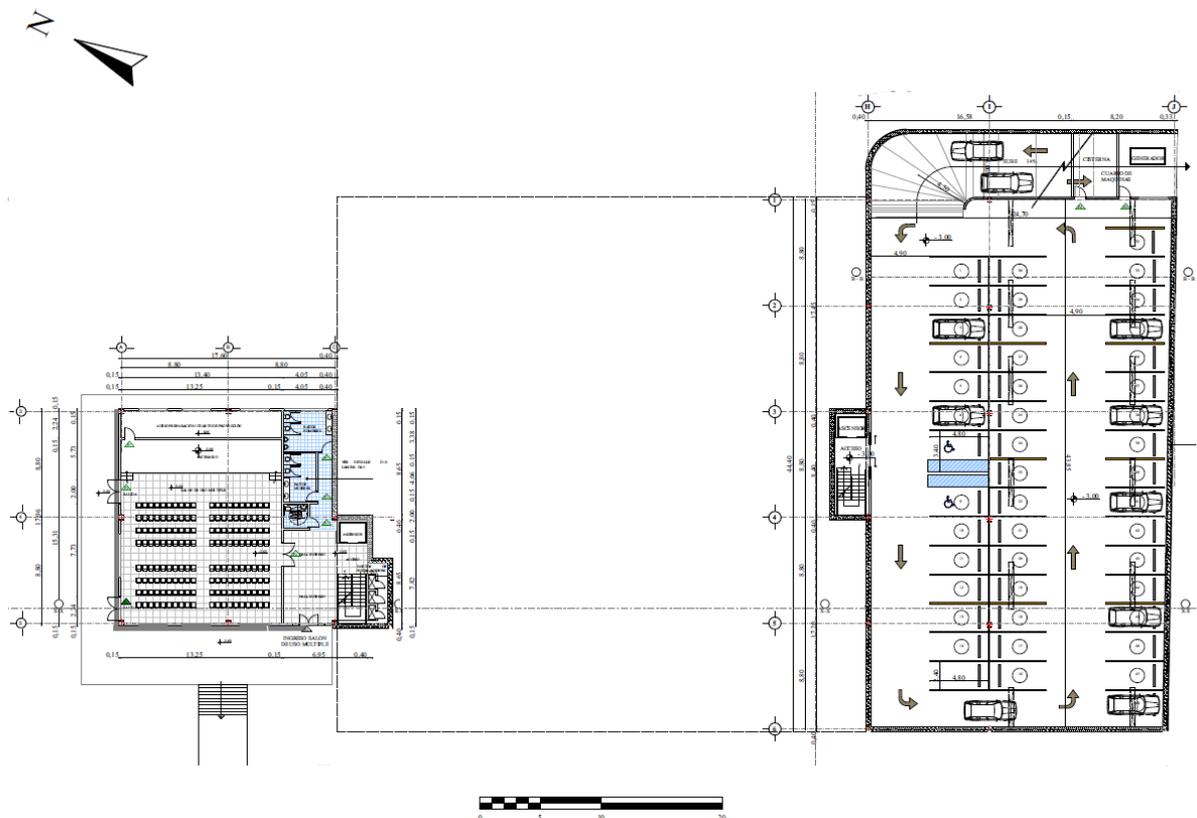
Planta subsuelo N – 3,00 / -3,60
